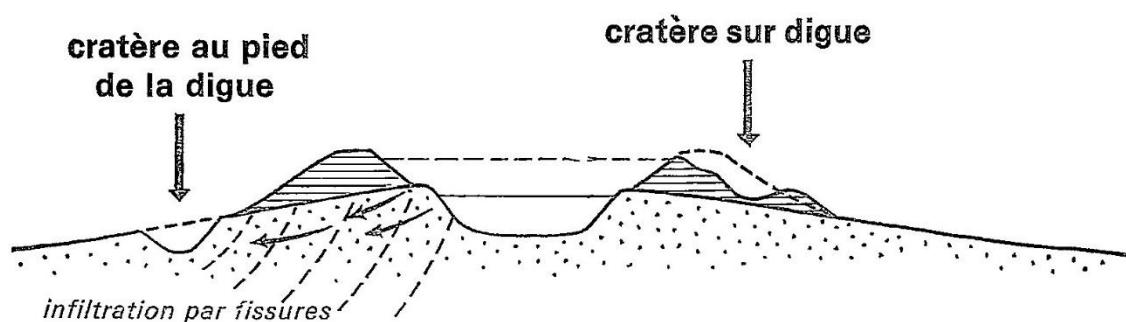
Crateras e infiltração por fissuras. Fonte: LACOSTE, 1976b, p.107.
